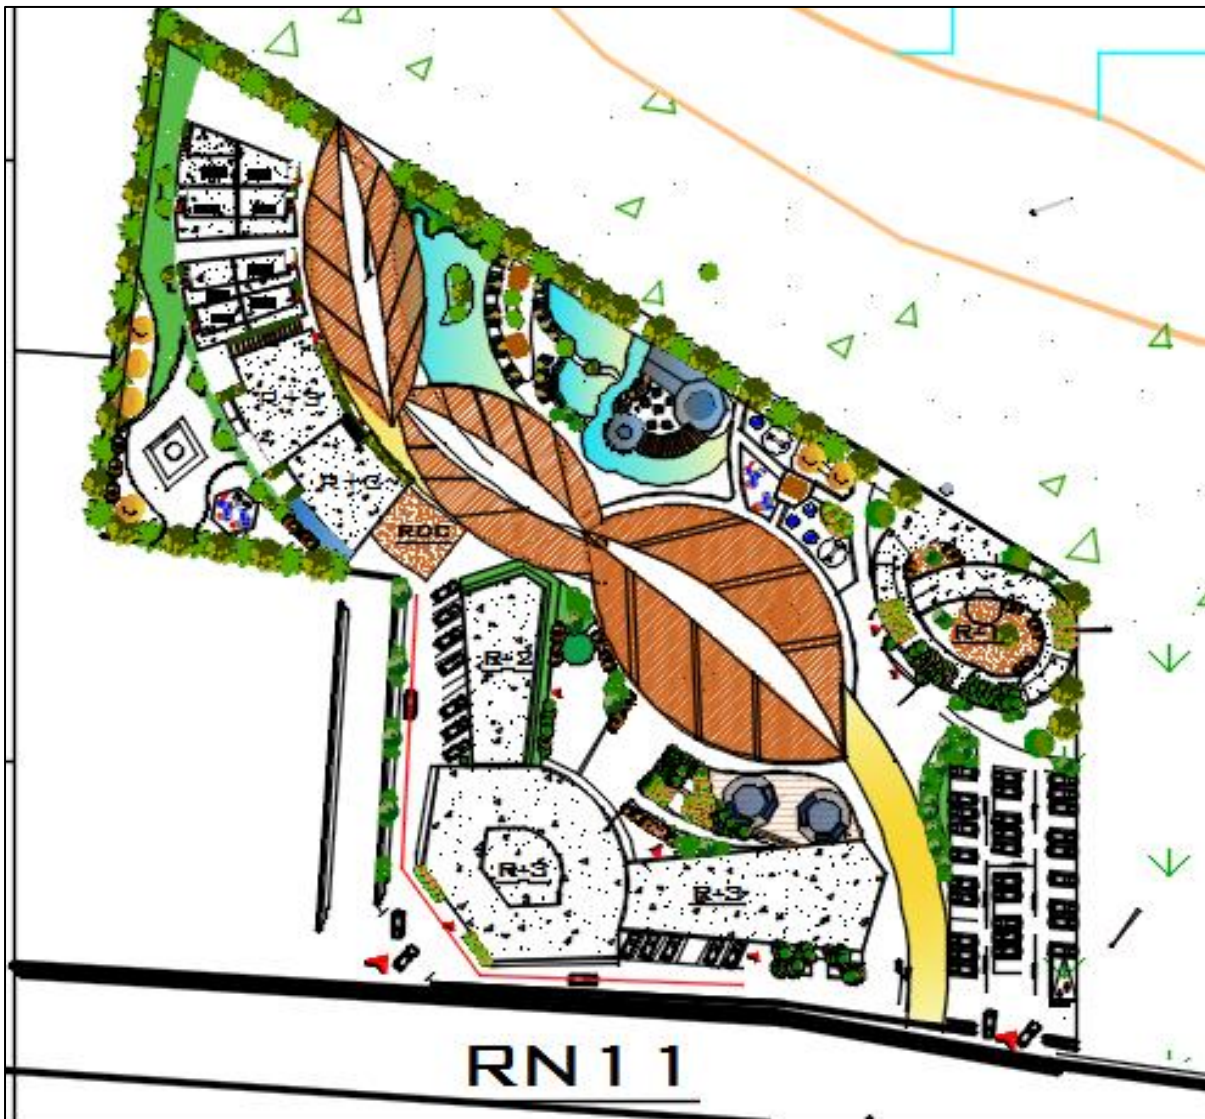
plan de masse des pôles sensibilisation et de loisirs
